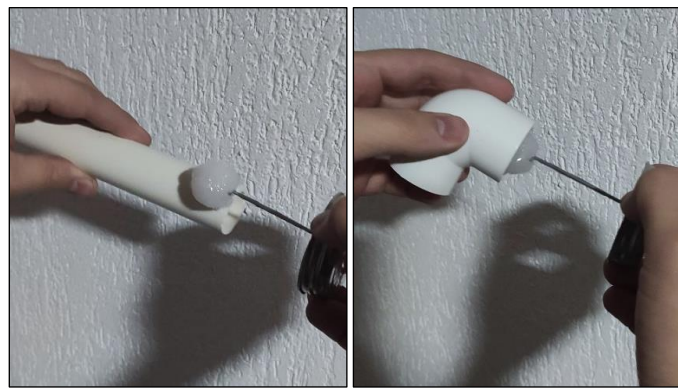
Colocación de pegamento en tubería de PVC pegable
